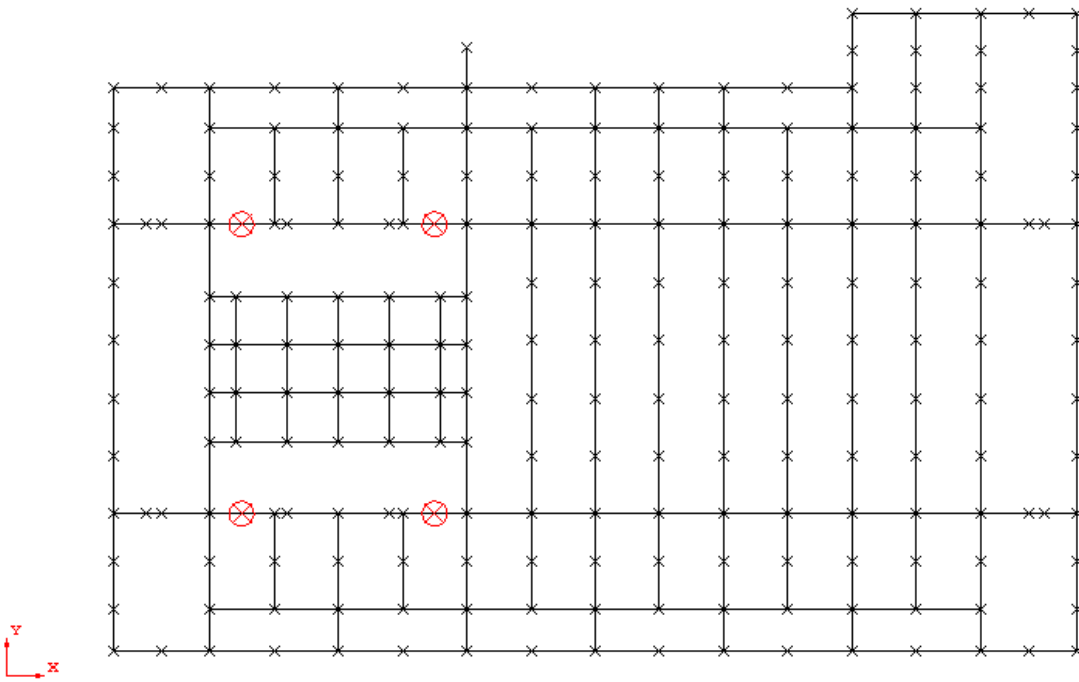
TORRE DE PERFORACIÓN – POSICIÓN DE CARGAS 3 – APLICACIÓN DE CARGASCUBIERTA SUPERIOR.
